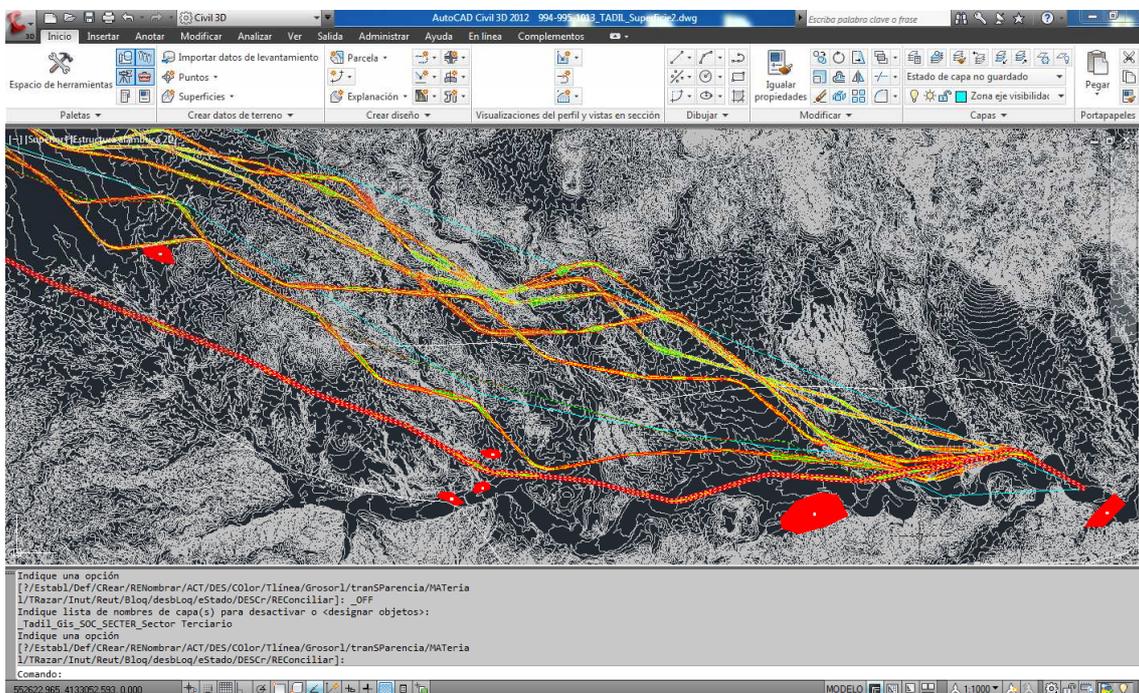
Detalle de la planta de las seis alternativas con solución.
